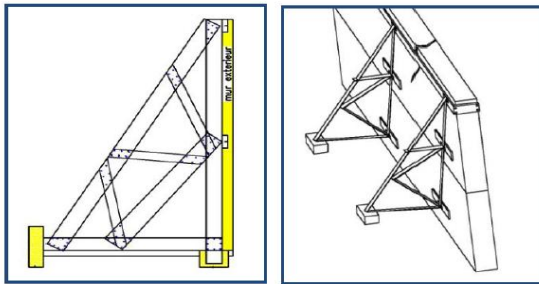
support d'etaimment a 45° pour un mur en risque d'effondrement
